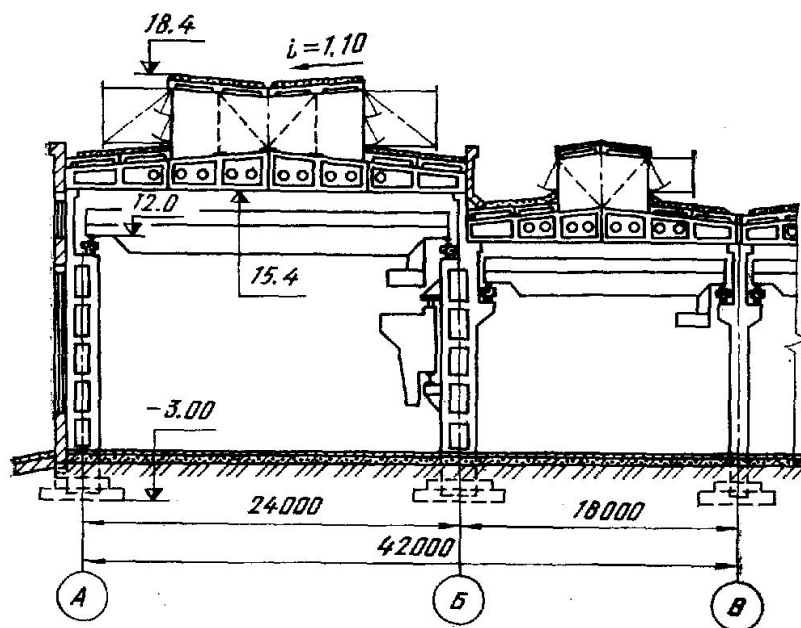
поперечный разрез цеха с железобетонным каркасом
